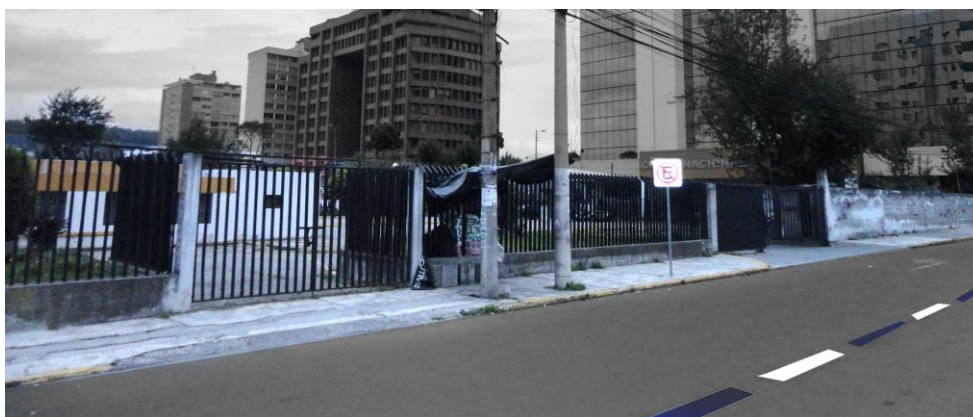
Lindero oeste, cerramiento de construcción mixta y puertas de acceso al parqueadero actual.
